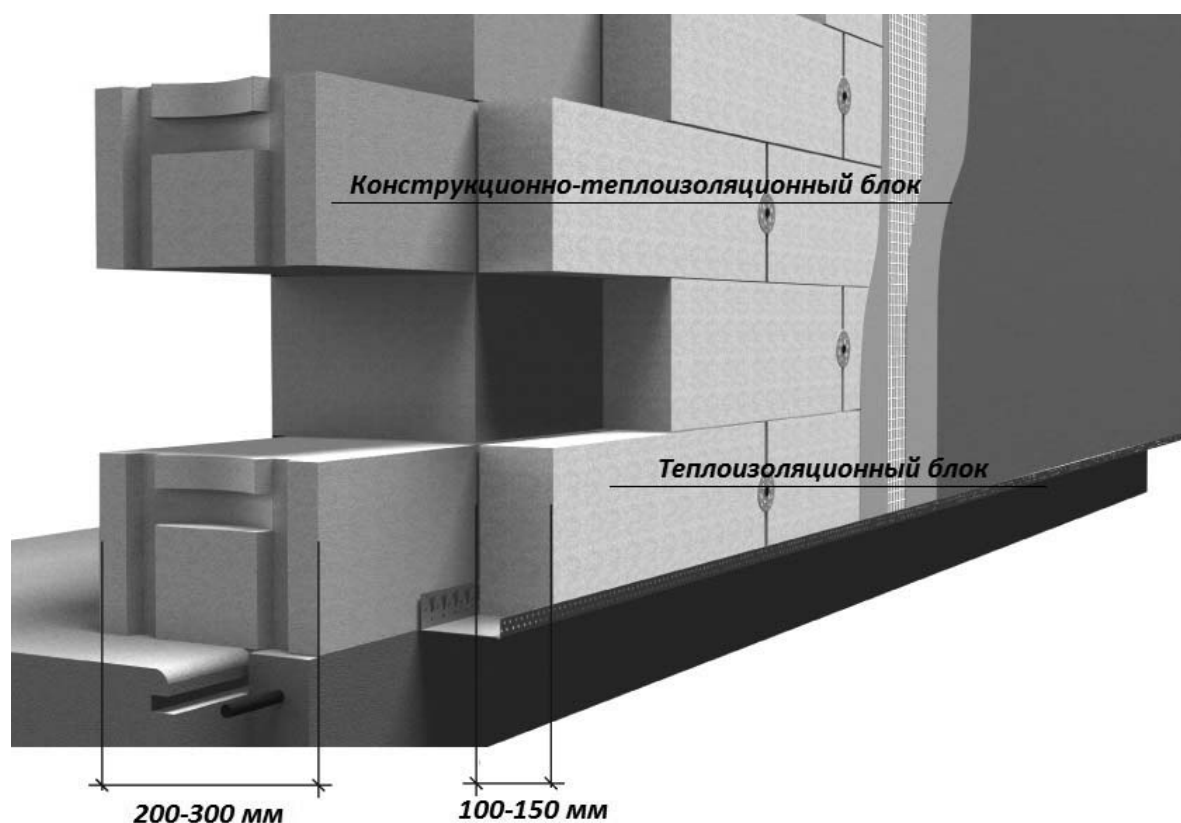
Двухслойная стена из газобетона D300-D500 в сочетании с теплоизоляционными плитами D150.
